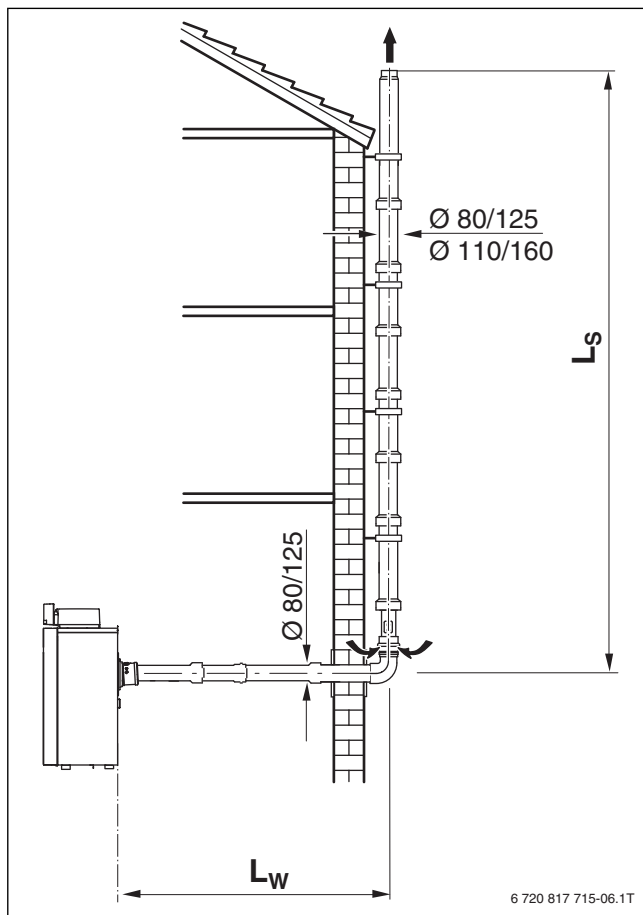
Guía de tubo concéntrico en la fachada (C<sub>53(x)</sub>)
